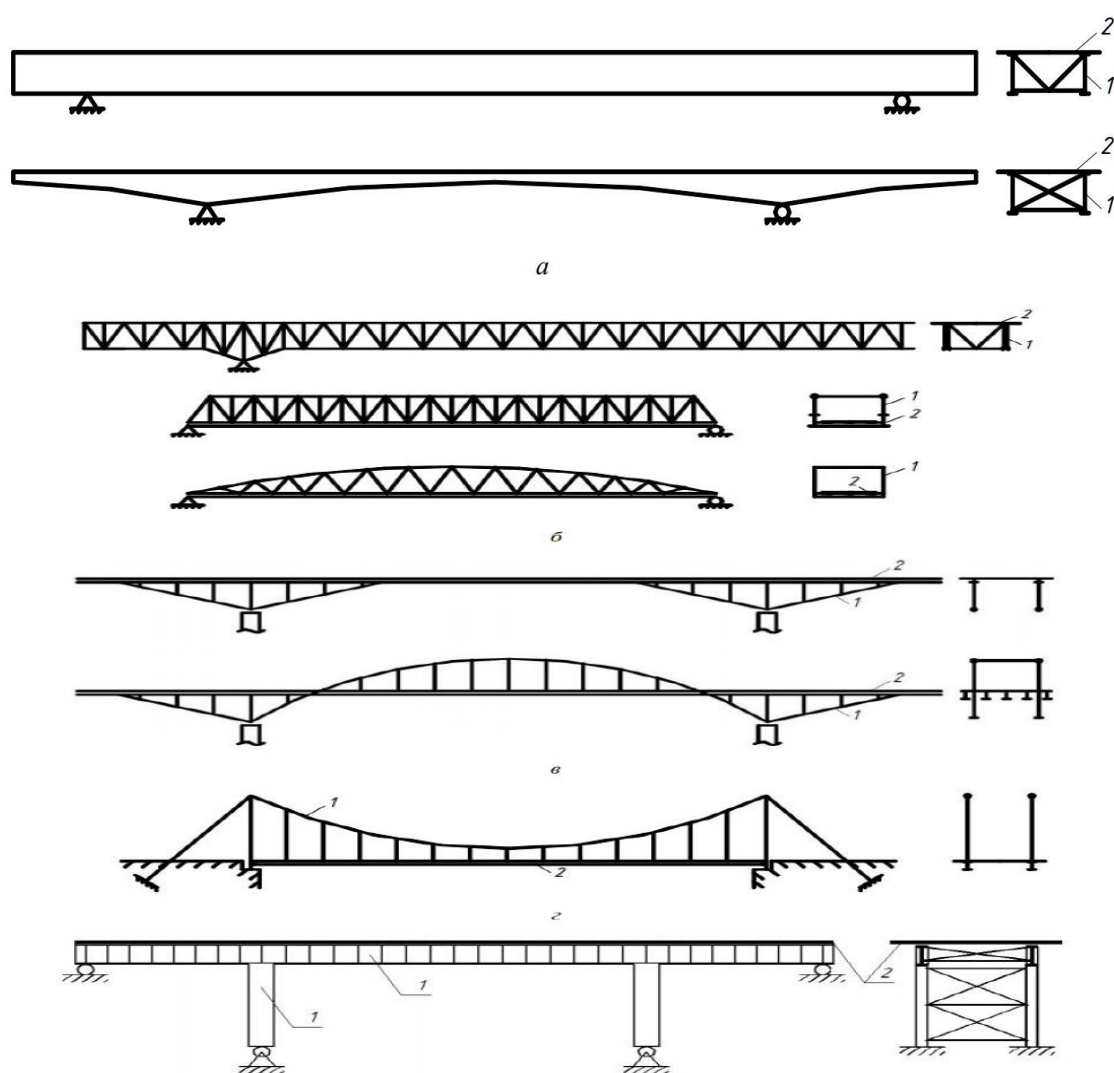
Конструктивные схемы сталежелезобетонных железнодорожных мостов, используемых на железных дорогах Украины и странах Европейского Союза
